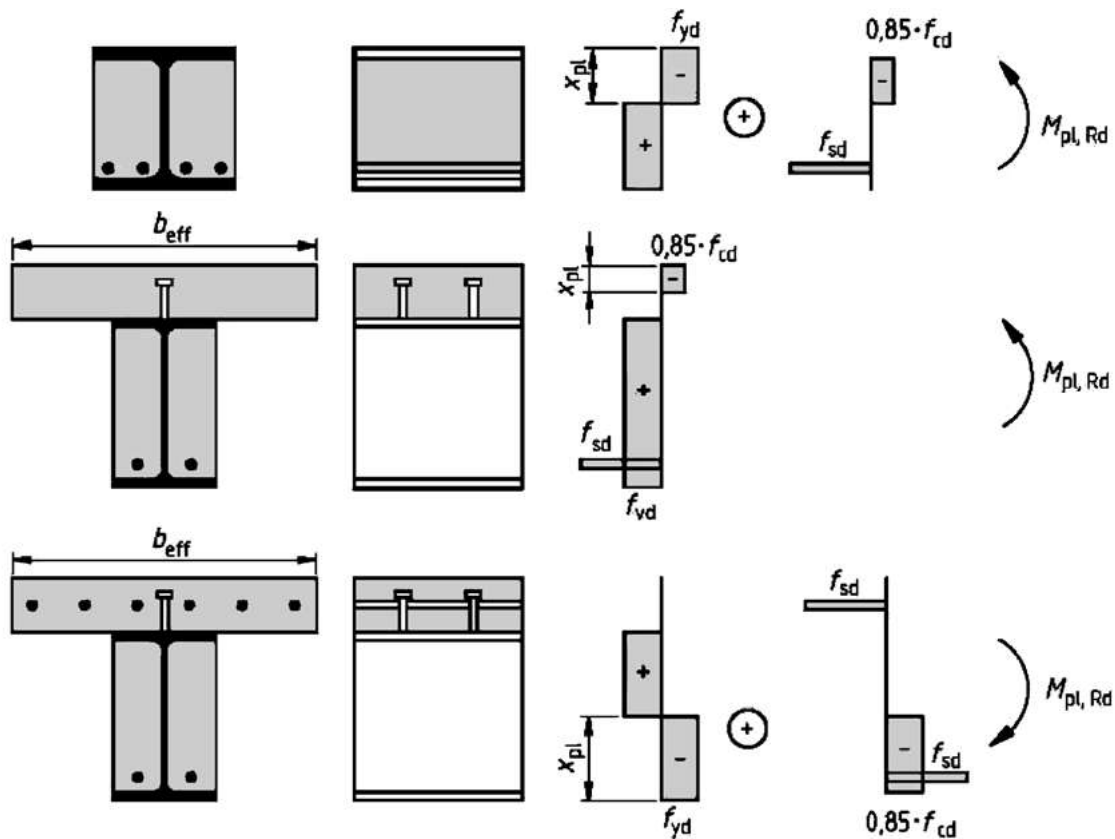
Примеры пластического распределения напряжений в сечении сталежелезобетонной балки с обетонированием стенки
